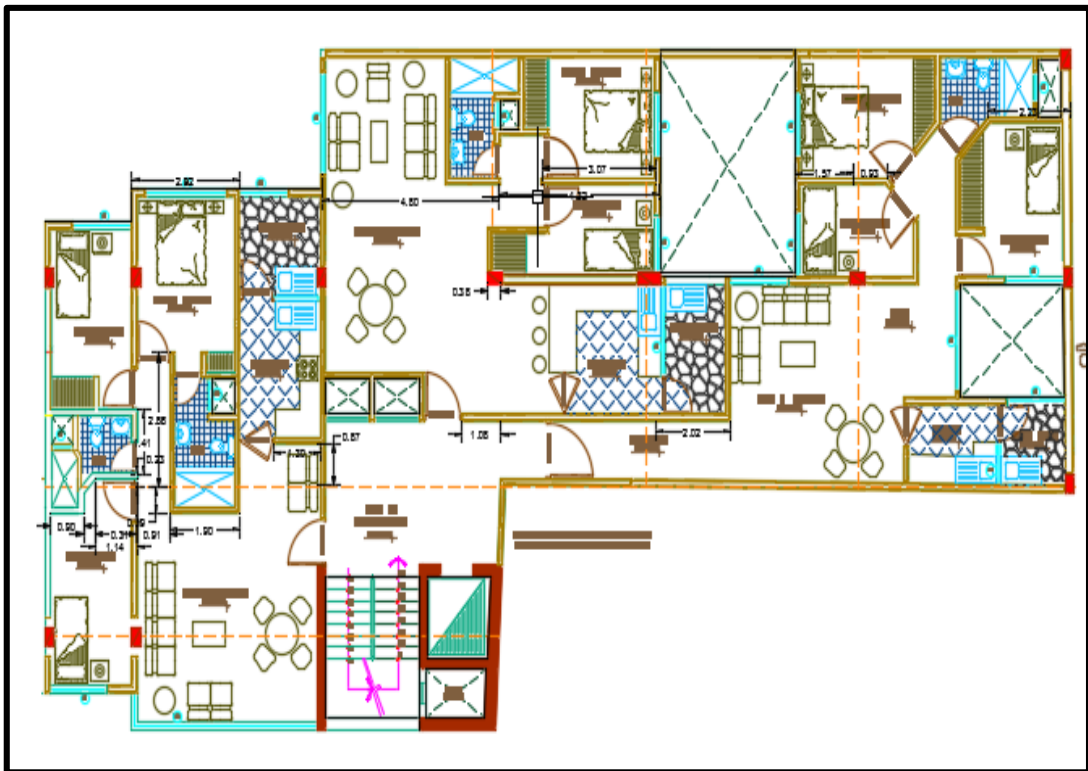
Planta Arquitectónica del 2do al 7mo Piso
